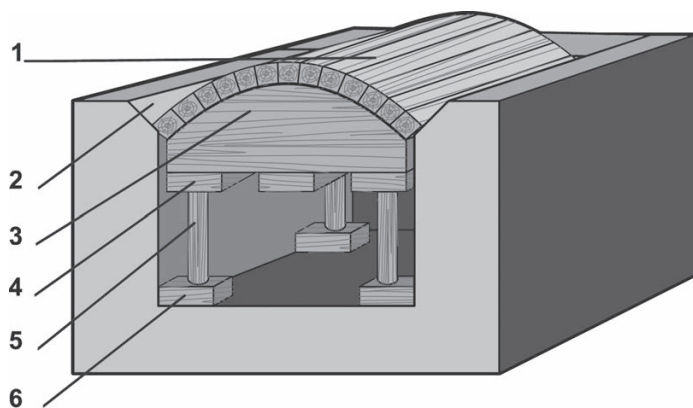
Опалубка в сборе: 1 — обшивка из реек; 2 — пята; 3 — кружало; 4 — прогоны; 5 — стойки; 6 — клинья (кирпичи под ними не показаны)
